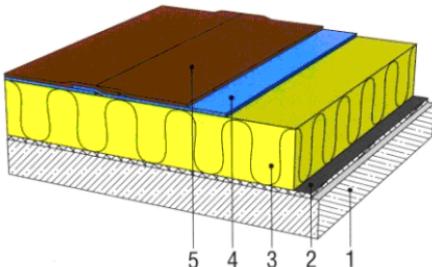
Однослойное теплоизоляционное решение кровли с двухслойным наплавляемым гидроизоляционным ковром и kleевым креплением: 1 — несущая железобетонная плита покрытия; 2 — приклейка горячим битумом, выполняющая роль пароизоляции; 3 — теплоизоляционный слой из плит РУФ БАТТС; 4 — нижний наплавляемый гидроизоляционный ковер; 5 — верхний наплавляемый гидроизоляционный ковер
